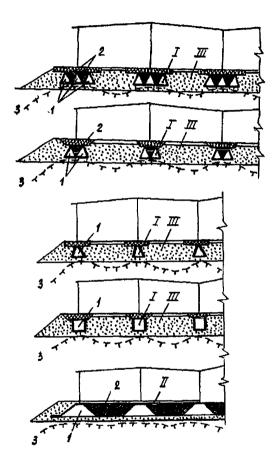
Схемы охлаждения грунтов оснований ленточных и столочатых фундаментов:
